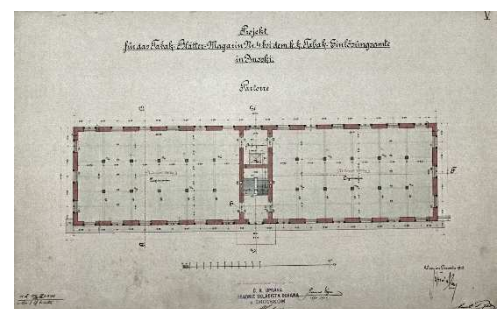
Lager IV, Projekt, 1910, Grundriss, Erdgeschoss.
